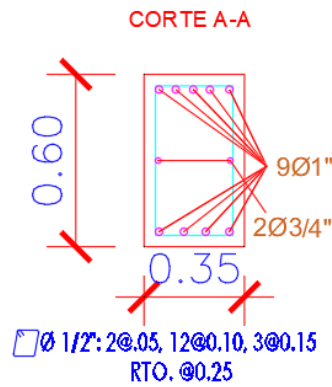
Secciones de Viga con Refuerzo 3° Piso
